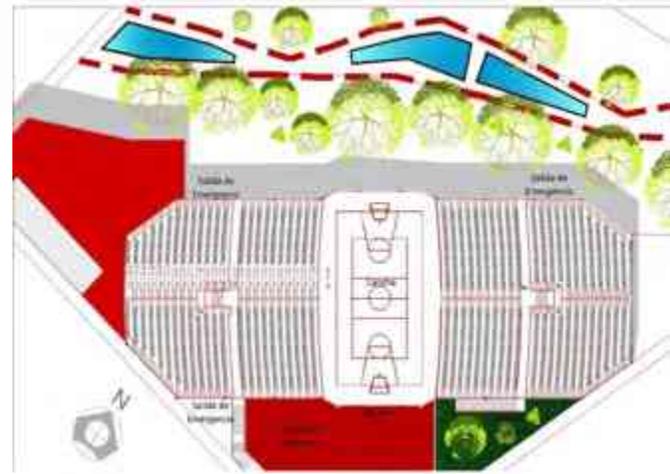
Planta arquitectónica de la primera idea para el Auditorio Deportivo. F.M.P.
